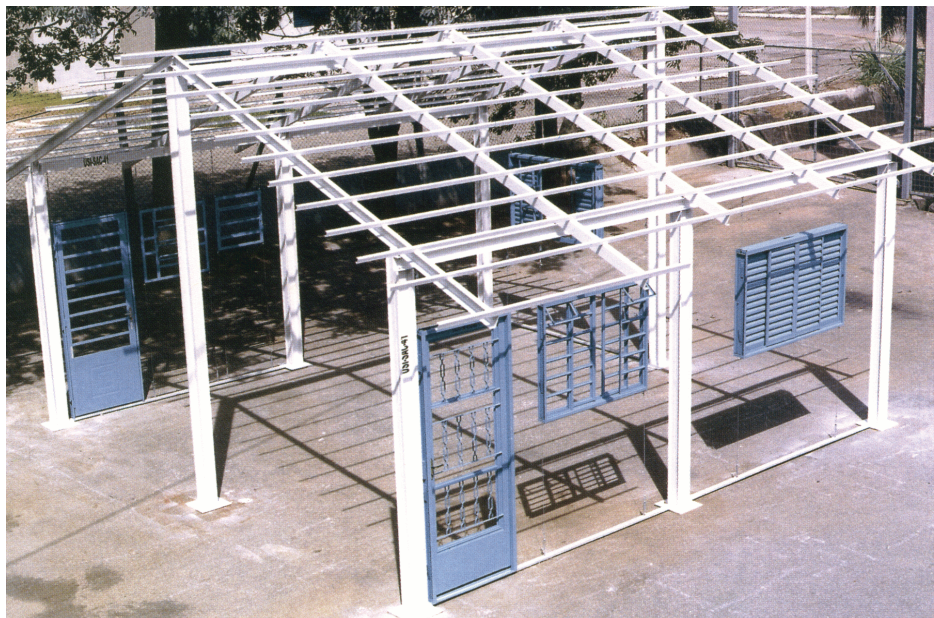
Estrutura Metálica da casa Usiteto
